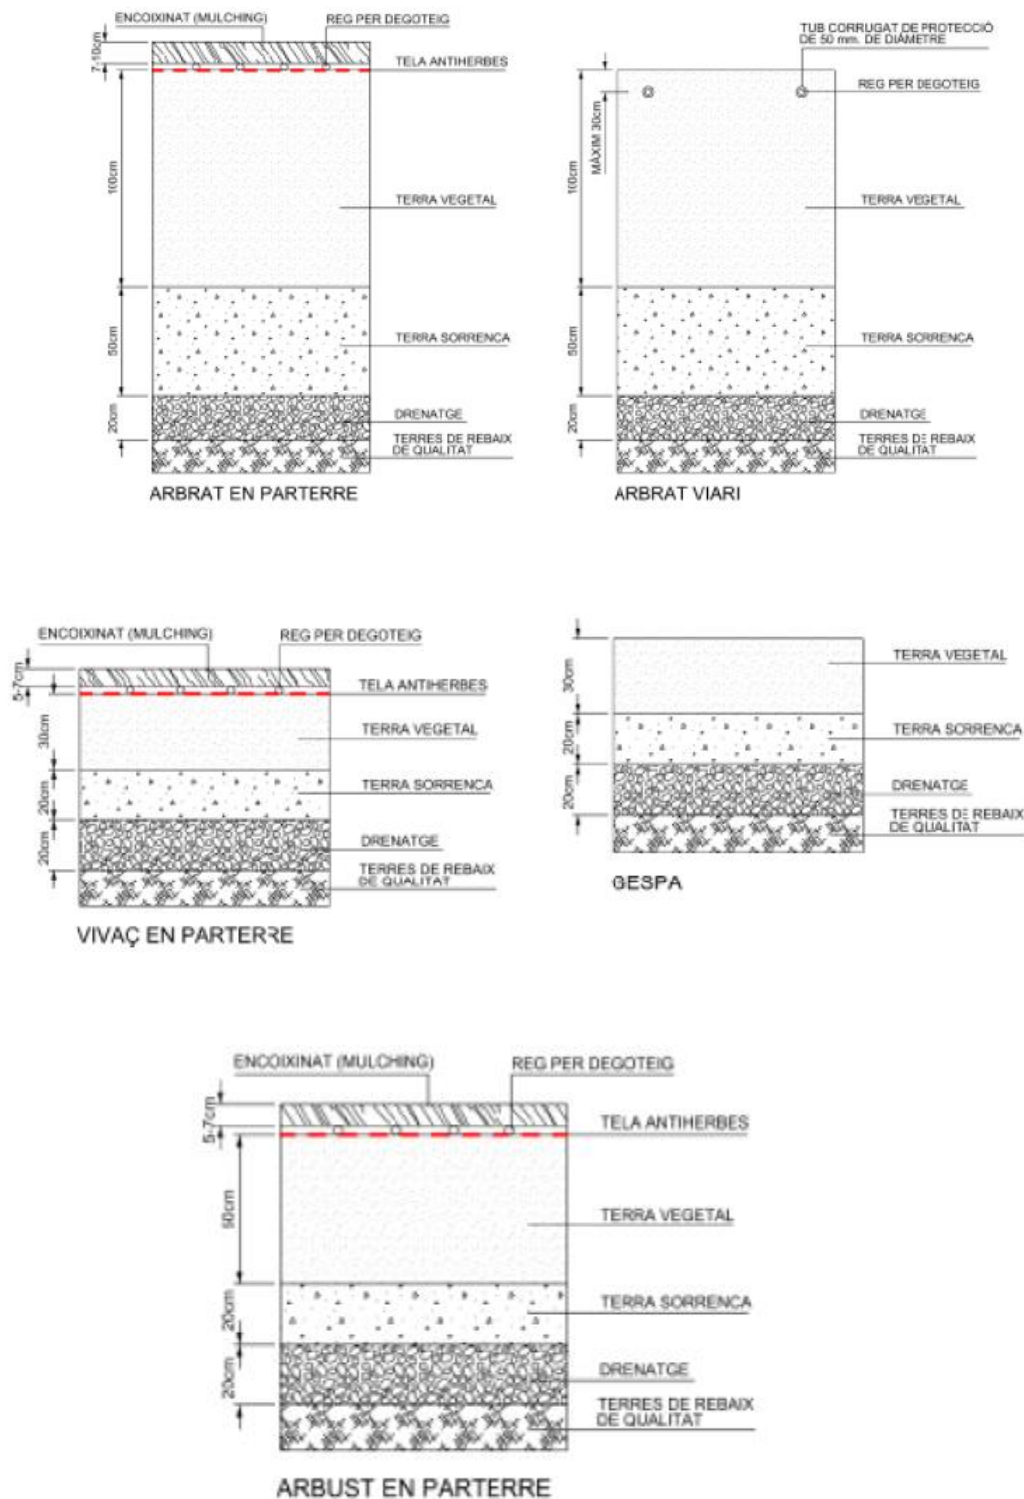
Perfils transversals de plantació segons tipologia de verd
